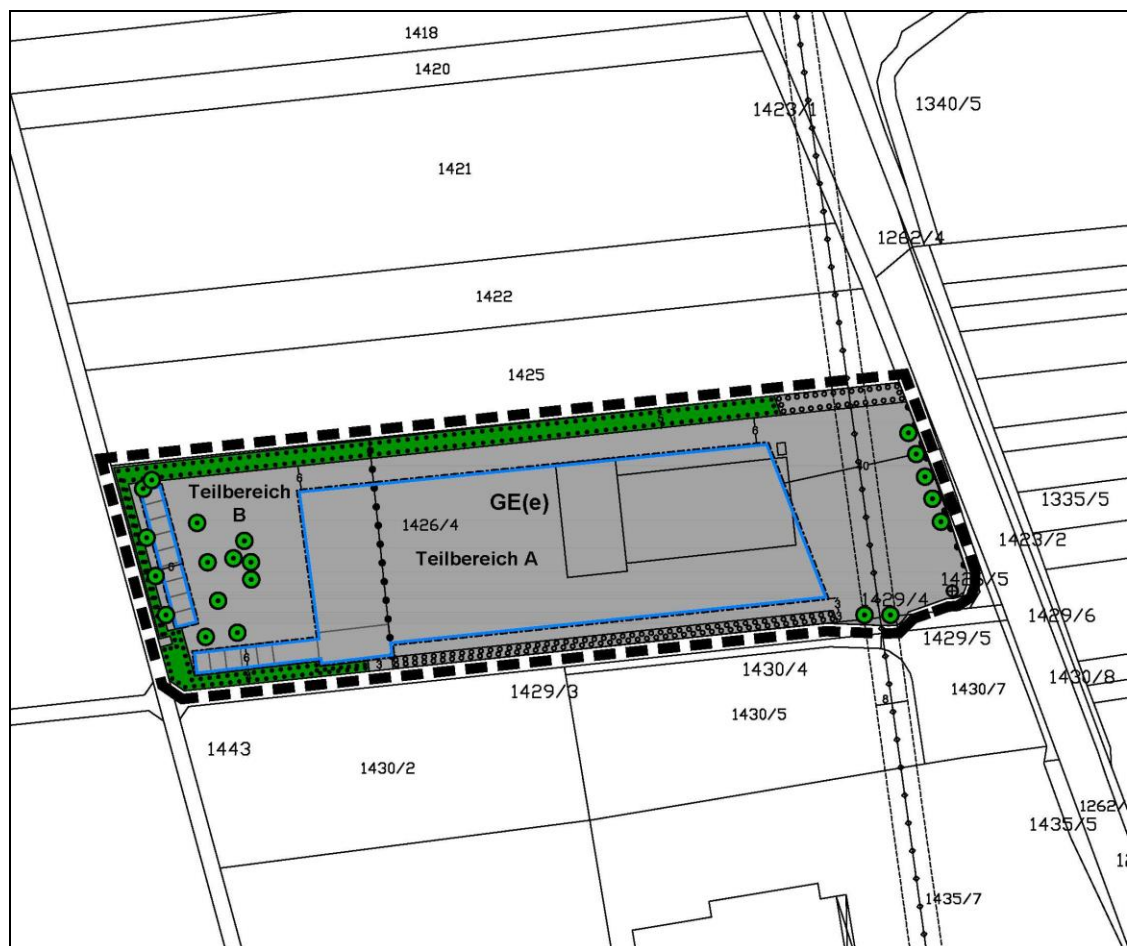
Bebauungsplan - Planzeichnung, Quelle: eigene Darstellung
